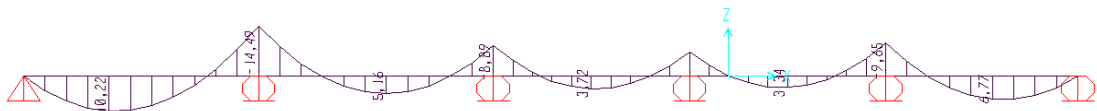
Moment fléchissant de la poutre a 5 travées.
